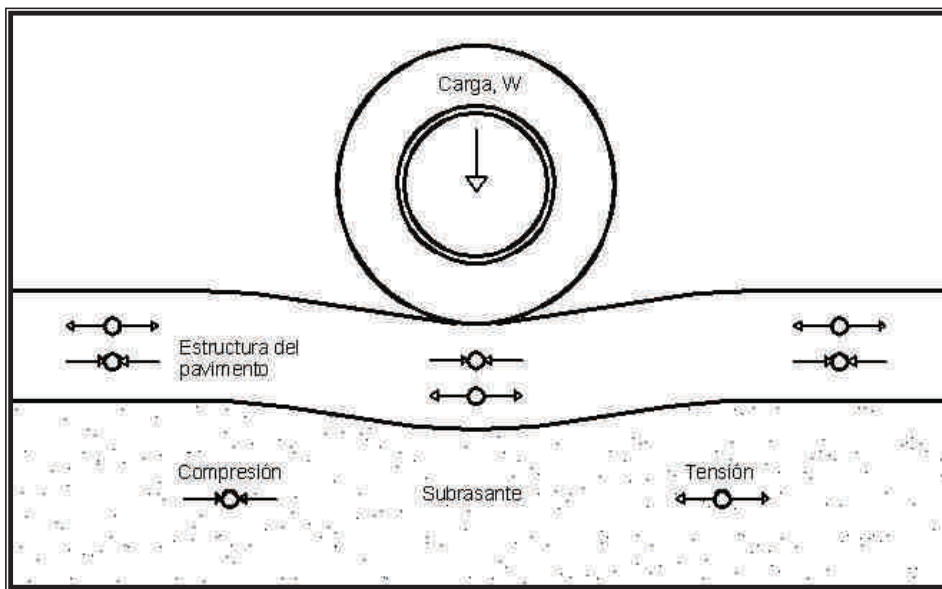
Distribución de la presión de carga de la llanta en la estructura del pavimento
